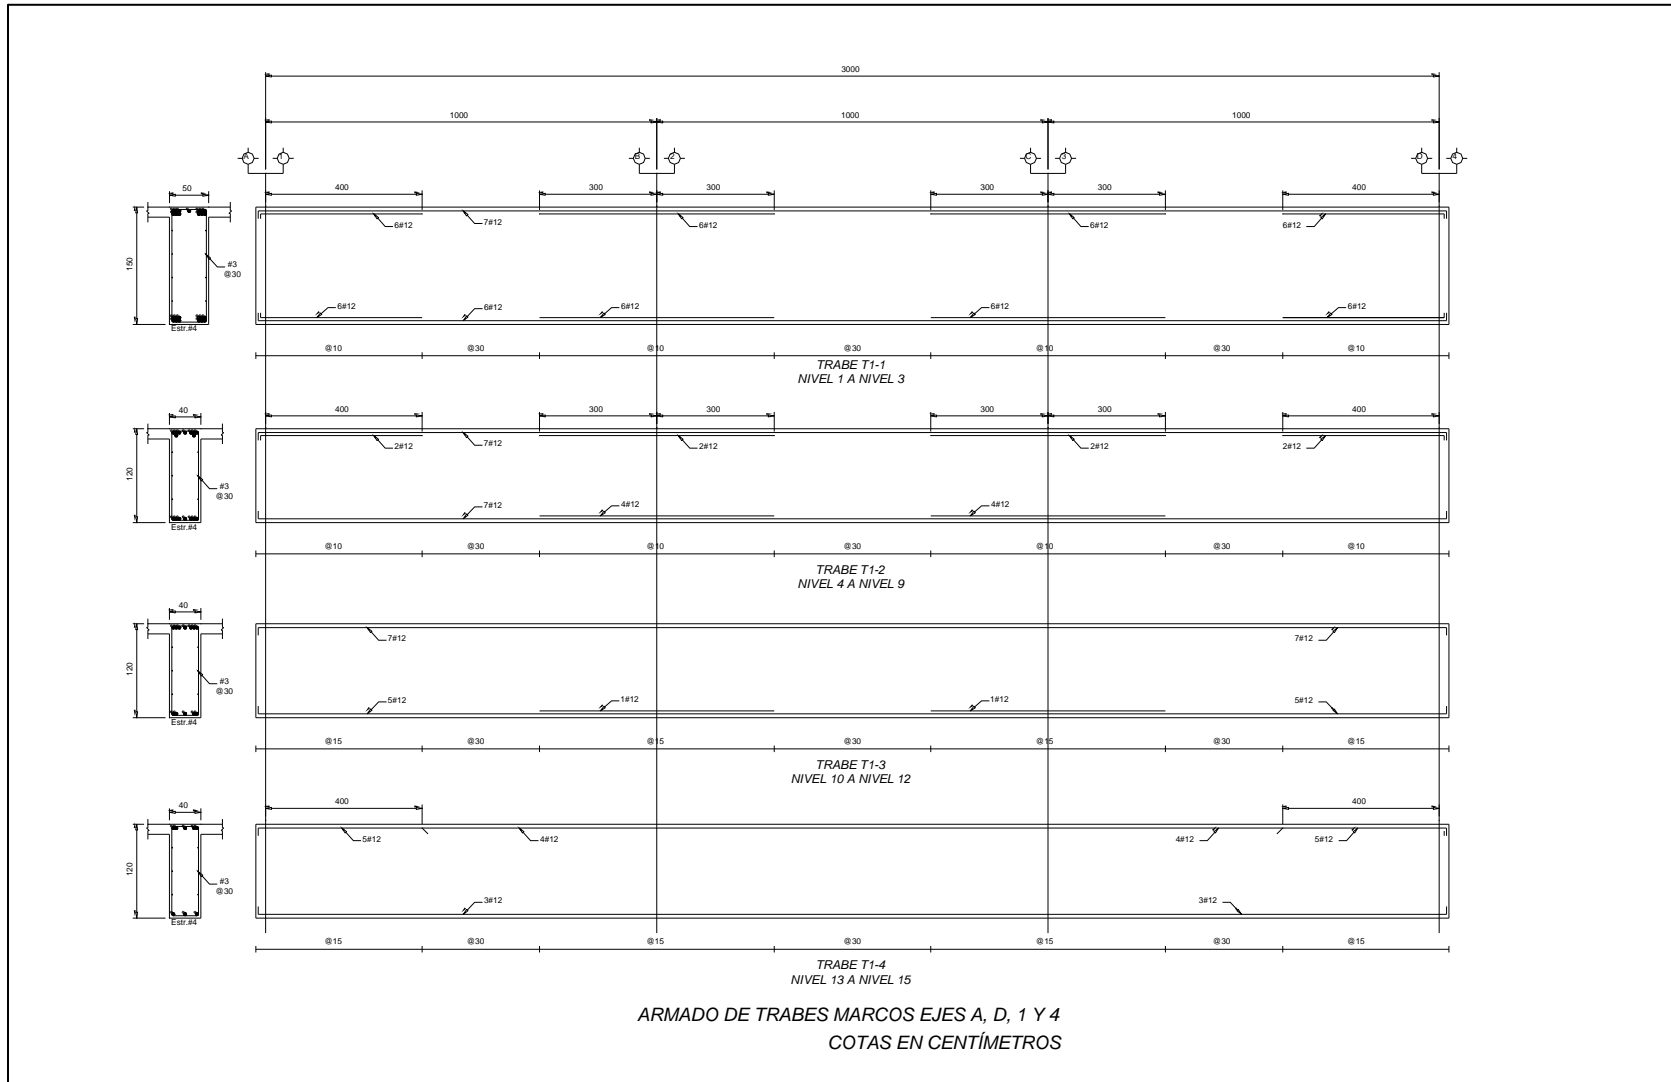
Detalles estructurales del edificio de 15 niveles diseñado con el ACI318-08
